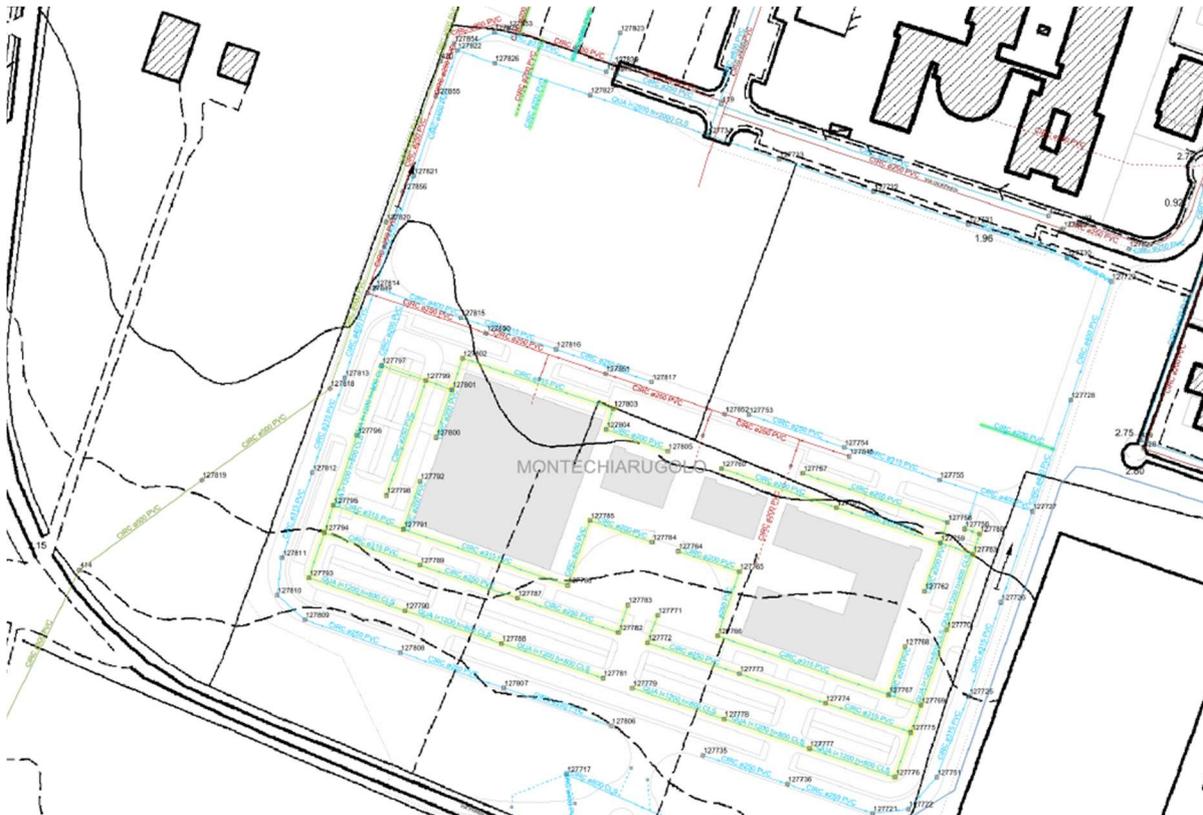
Planimetria delle reti fognatura, acquedotto e gas – Tratto 2
